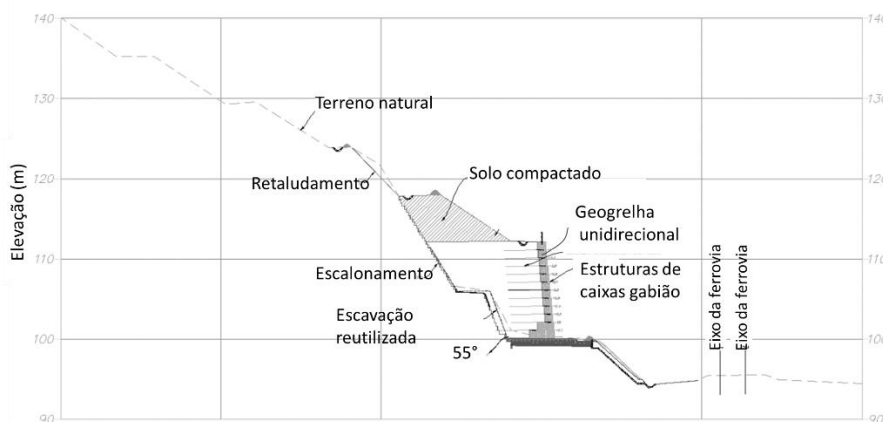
Seção transversal típica da estrutura de contenção instabilizada (Fonte: VALE adaptado).
